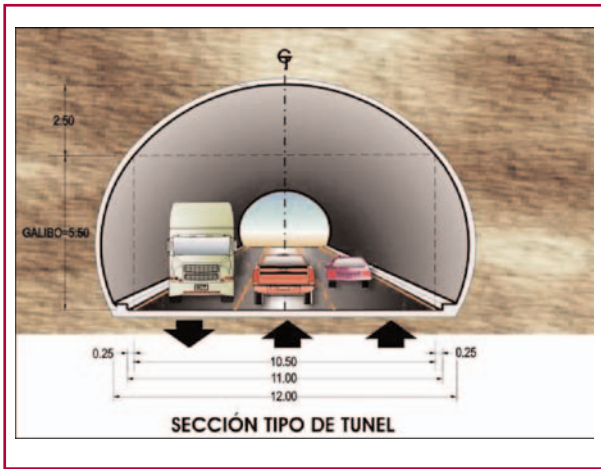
Autopista Durango-Mazatlán. Sección tipo 2ª fase (Poon, 2009).
